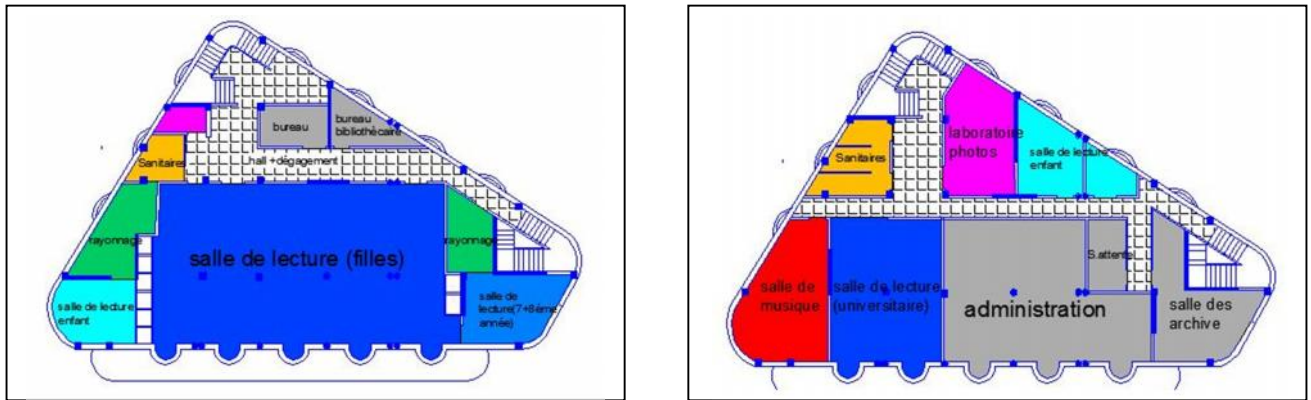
De gauche à droite le plan de deuxième étage et le plan de troisième étage
